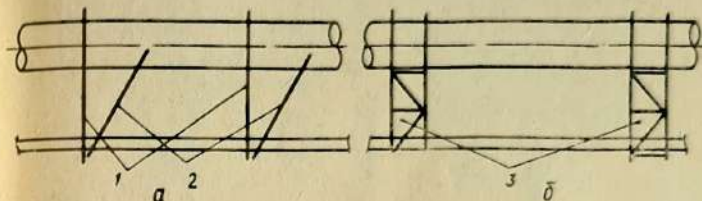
Подвеска сопутствующих трубопроводов:
